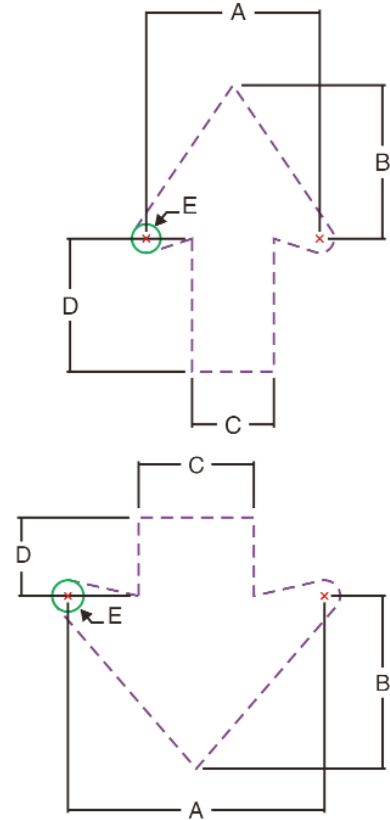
Dimensión de las flechas a instalarse en estructuras elevadas
